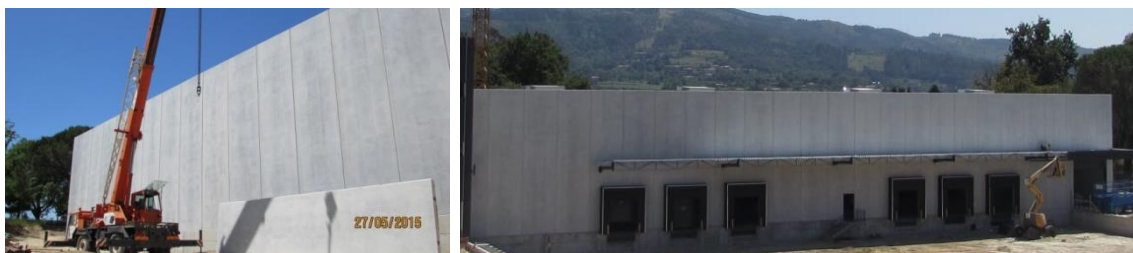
Colocação do painel pré-fabricado (à esquerda) e Fachada Norte revestida com painéis pré-fabricados (à direita)
